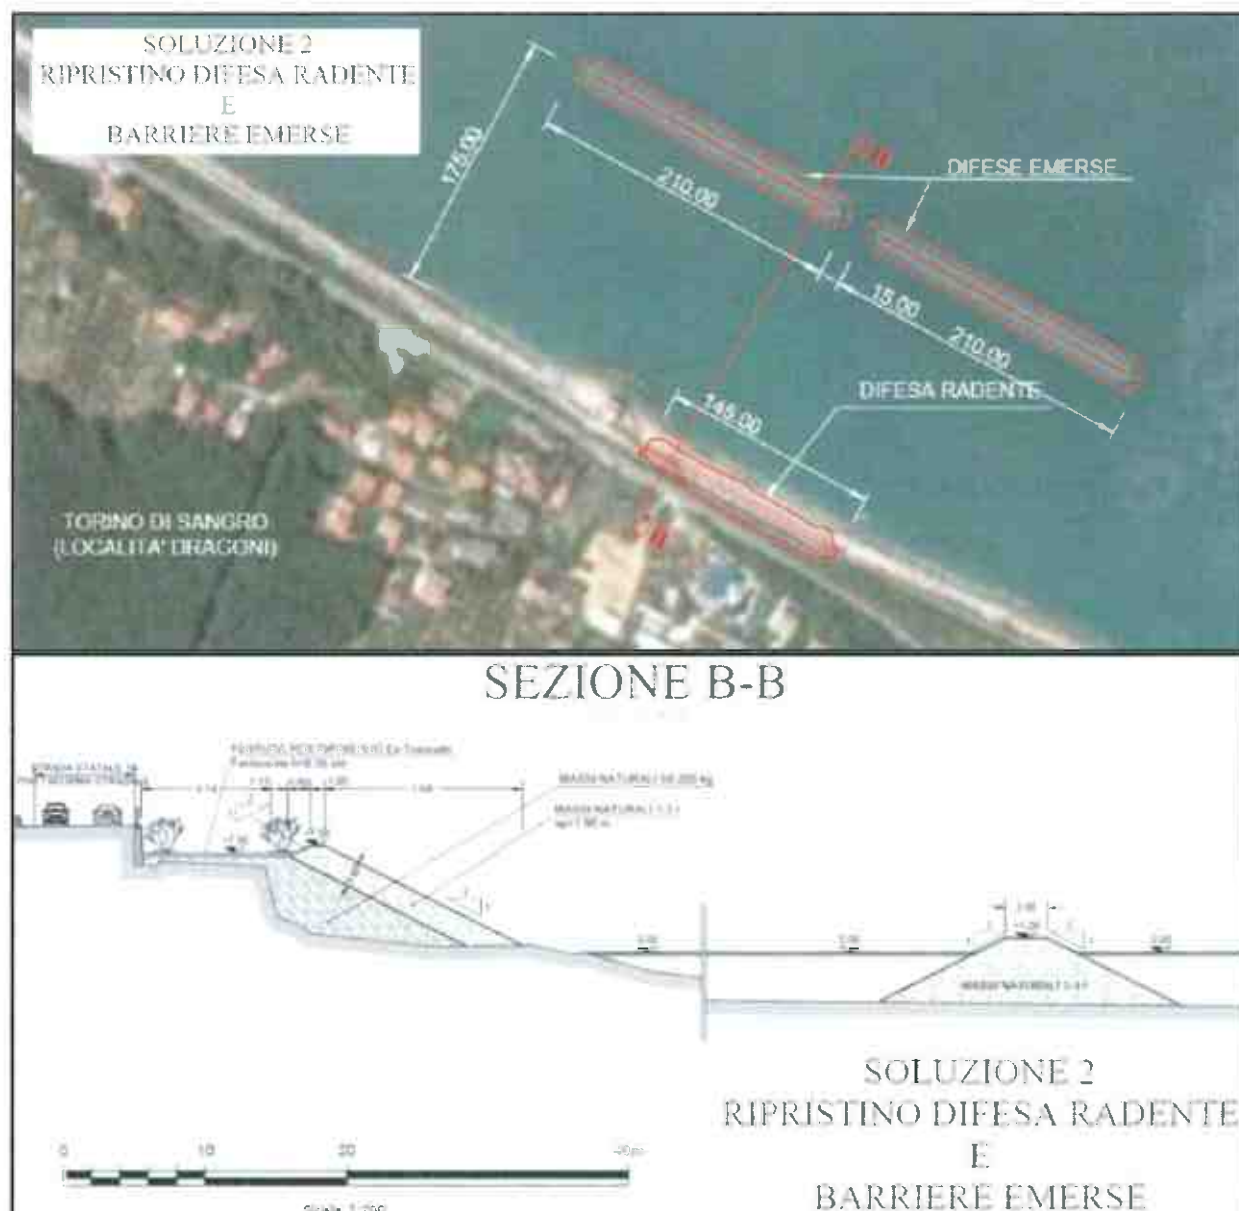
Planimetria e sezione tipo Soluzione 2 (dallo SIA).
